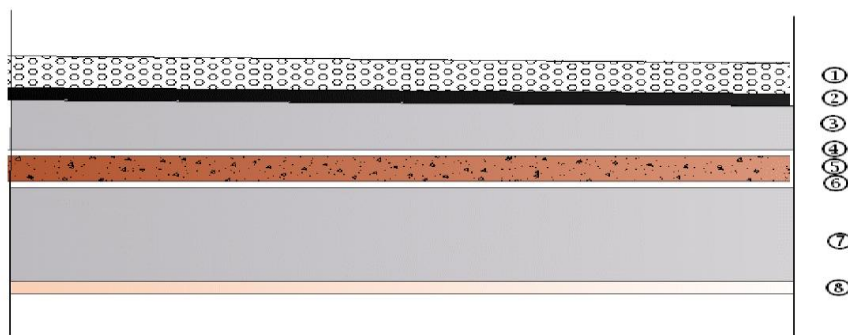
Coupe transversale au niveau de plancher étage terrasse.
